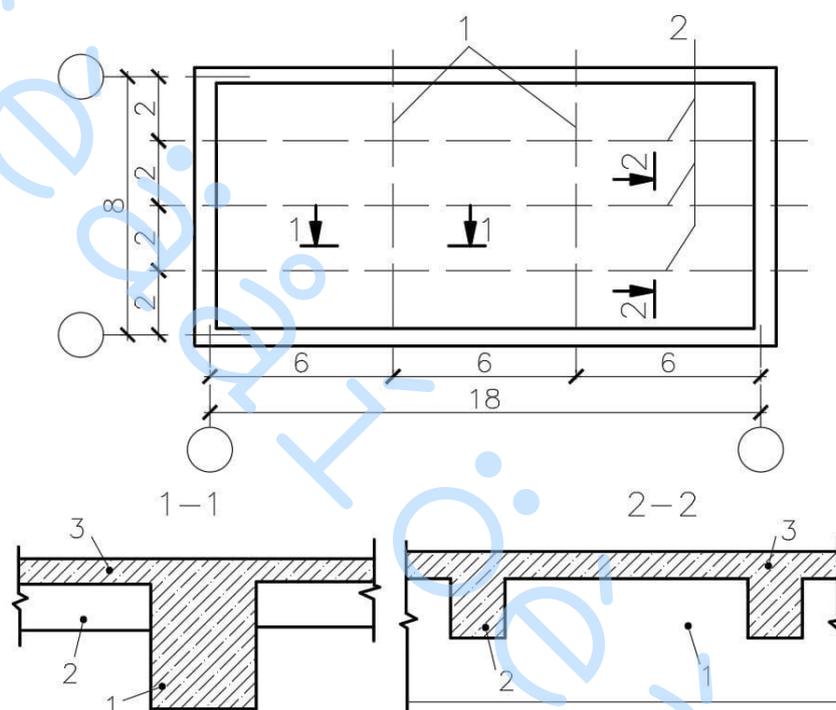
Железобетонное монолитное ребристое перекрытие:
